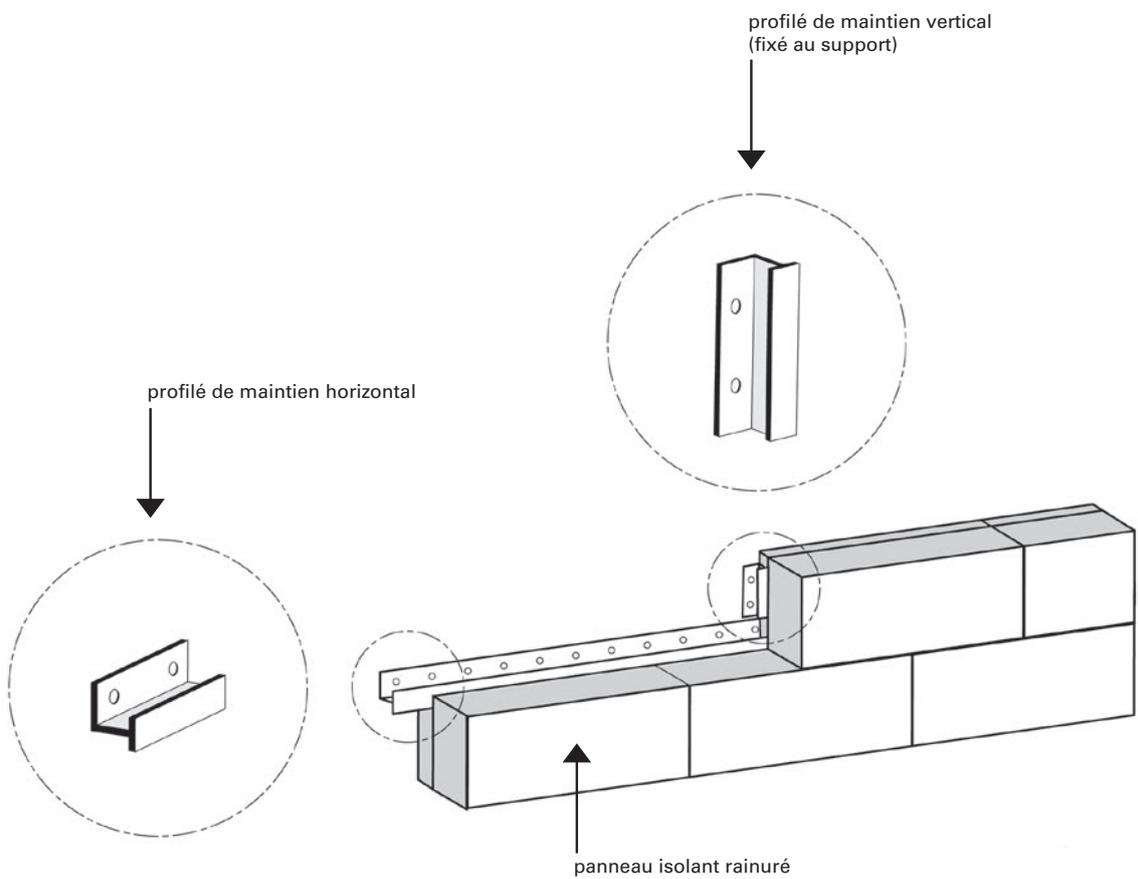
Fixation des panneaux isolants par profilés – Utilisation de profilés de maintien vertical
